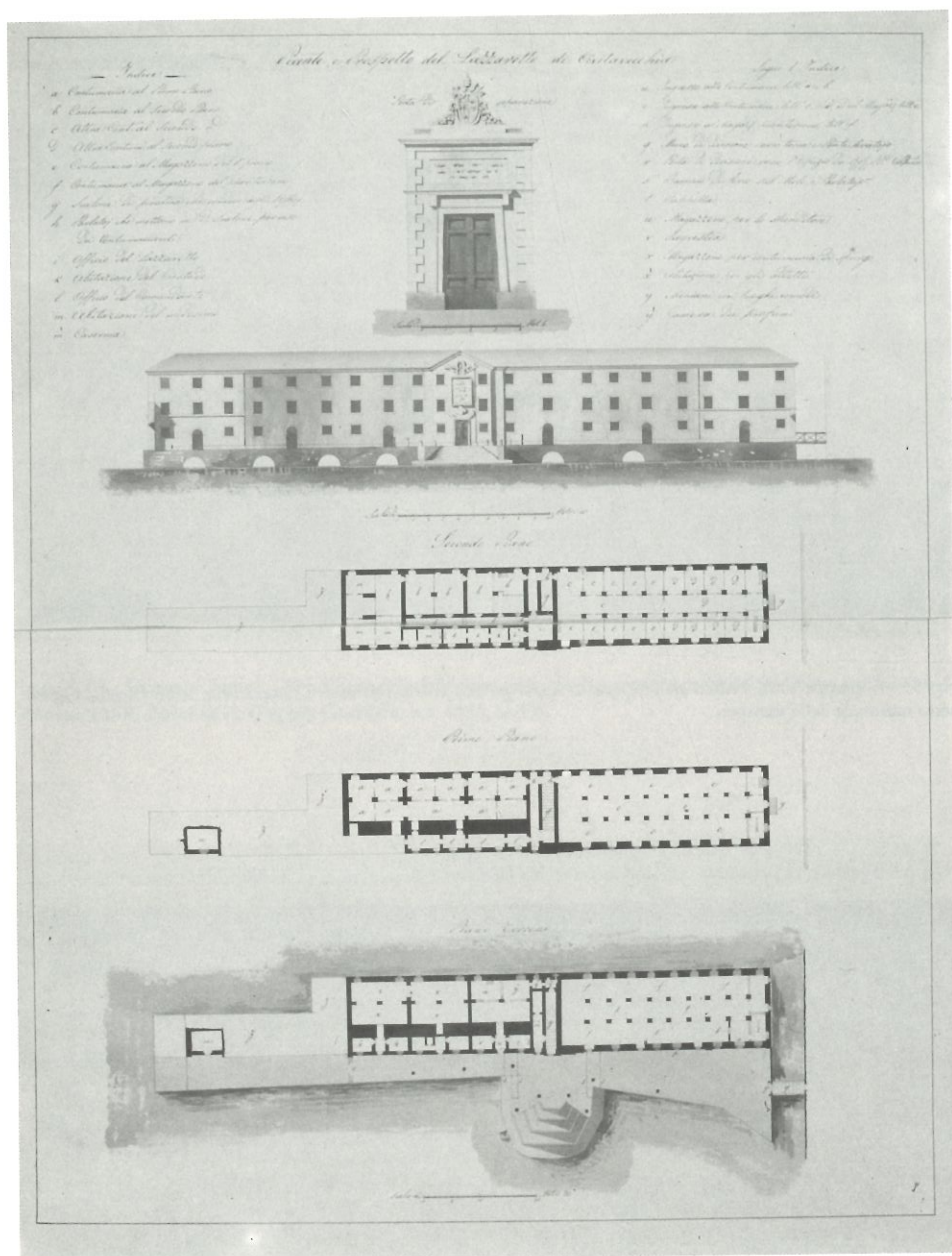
Il granaio di Benedetto XIV in Civitavecchia all'inizio del XIX secolo, progetto di trasformazione in Lazaretto (ASR, *Disegni e mappe*, Collezione I, cart. 19, n. 284).
